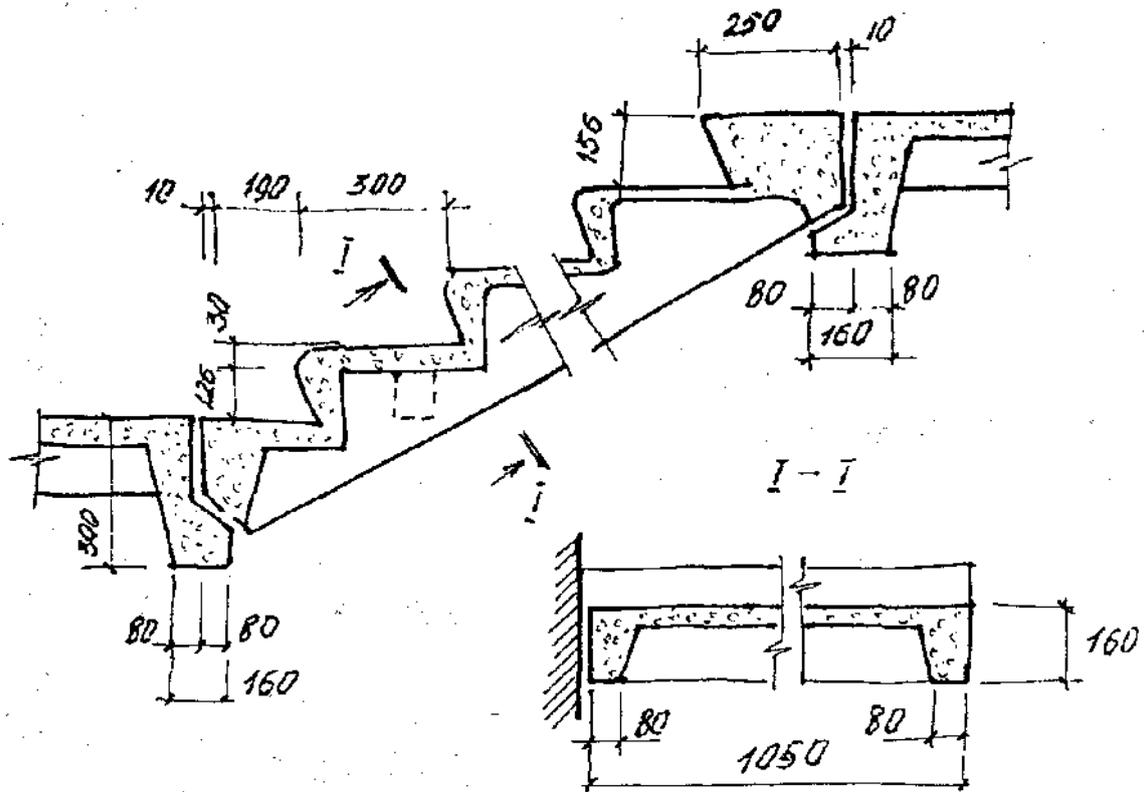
Сборные железобетонные лестничные марши со складчатыми ступенями
